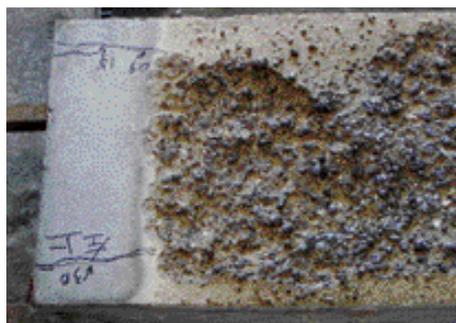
鉄筋配置の供試体の爆裂状況
